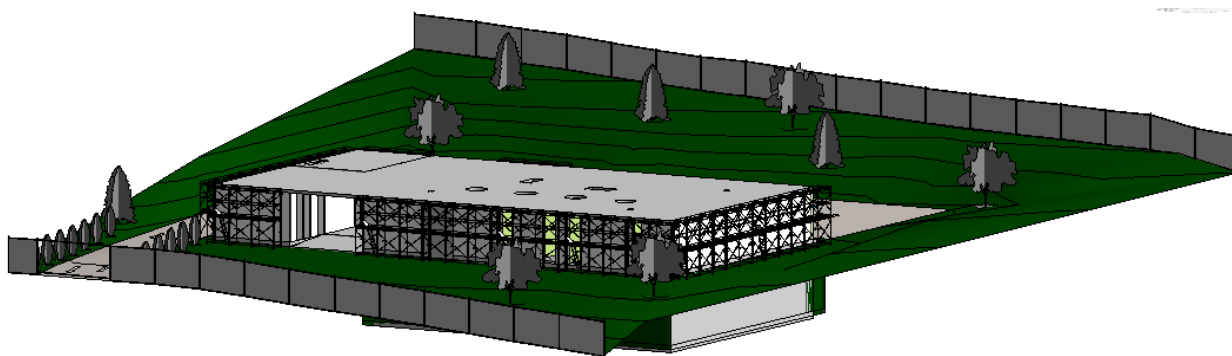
Vista geral do modelo de arquitetura e elementos de segurança em 3D
